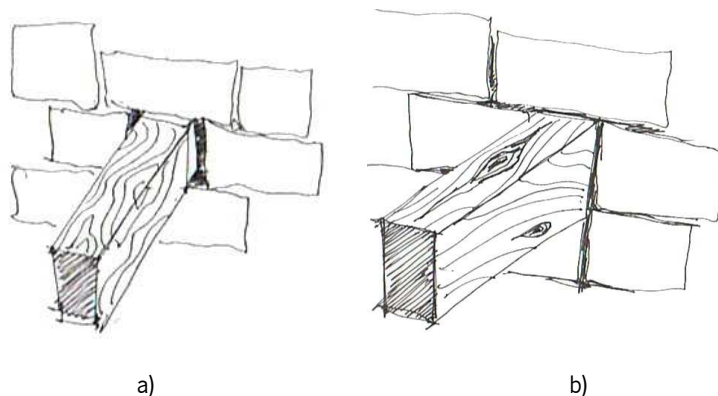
Identificação da ventilação dos apoios: a) apoio bem ventilado; b) apoio mal ventilado.
